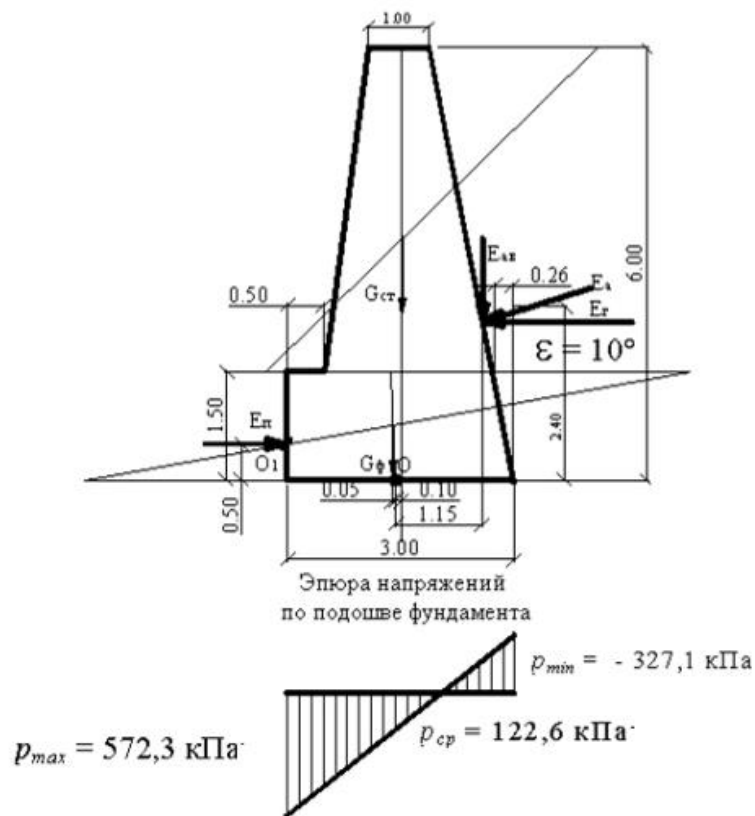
Поперечное сечение подпорной стены и силы, действующие на нее, эпюры напряжений по подошве фундамента
